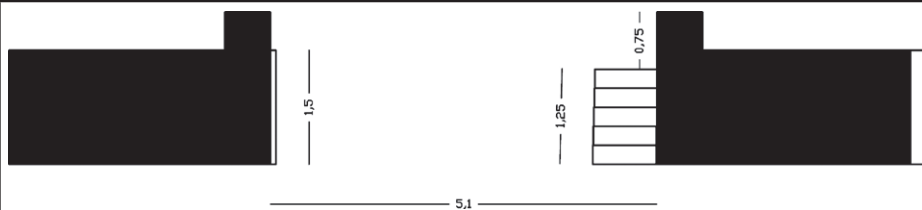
مسقط أفقي للصور الغربي مع مبنى البوابة الشمالية في الدملوة (رسم الباحث)
